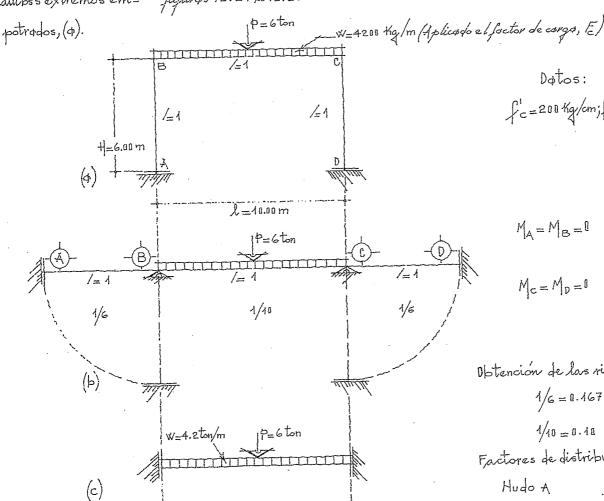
Algirar los postes se tiene una viga de tres tramos, (b). Fig. 12.29. Tramo de la riga BC, (c).
